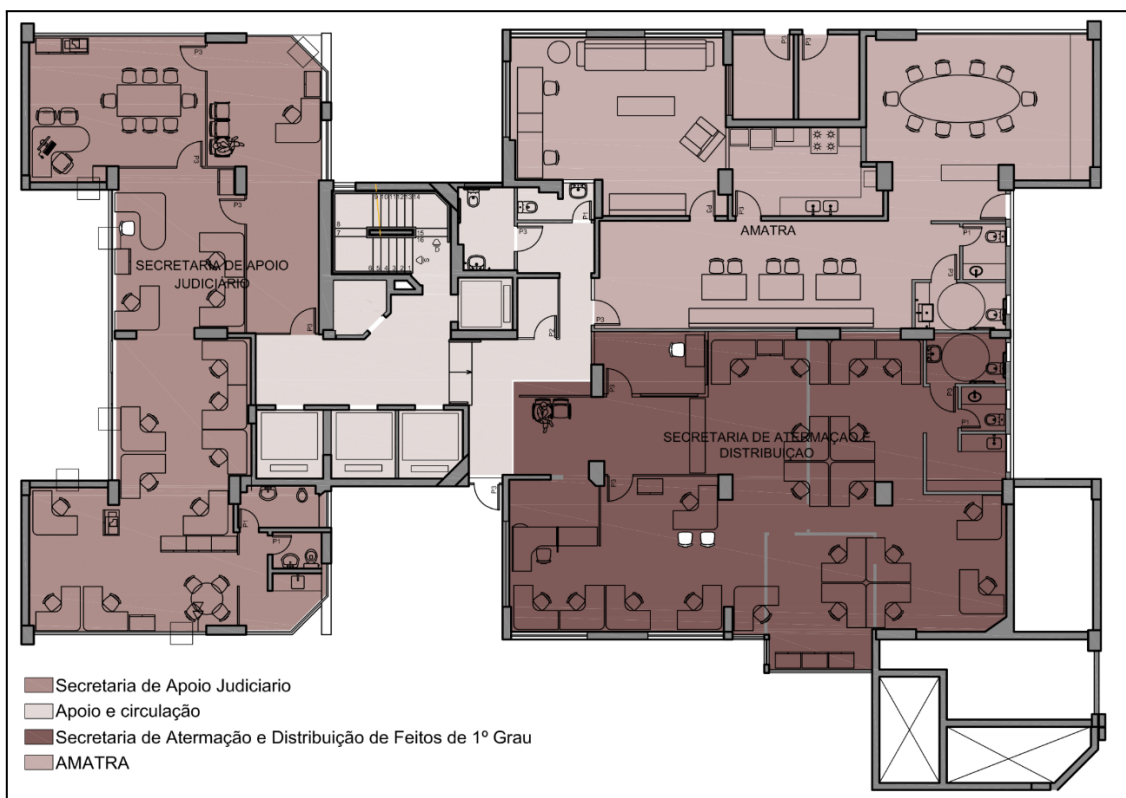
Planta atual do 3º pavimento do prédio da Rua Goitacazes 1475.
